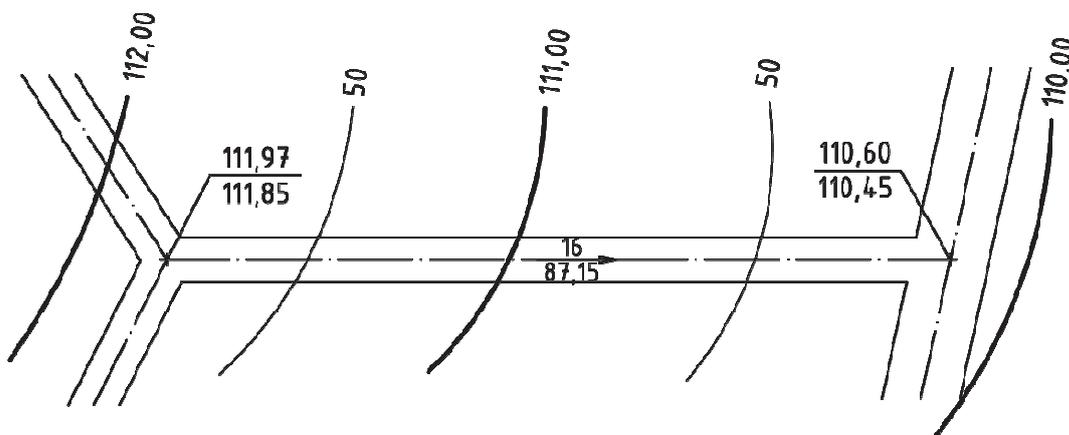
Пример схемы вертикальной планировки садово-парковой дорожки
